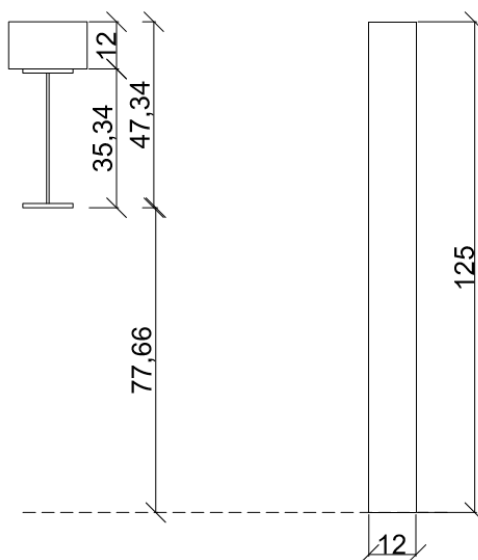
Diferença de altura entre a viga mista (a) e a viga de concreto (b); figura sem escala; medidas em cm
